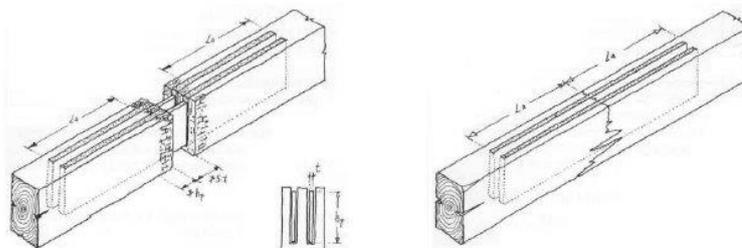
Reforço através da aplicação de placas de reforço internas seladas com cola epoxídica (Arriaga, 2002)
